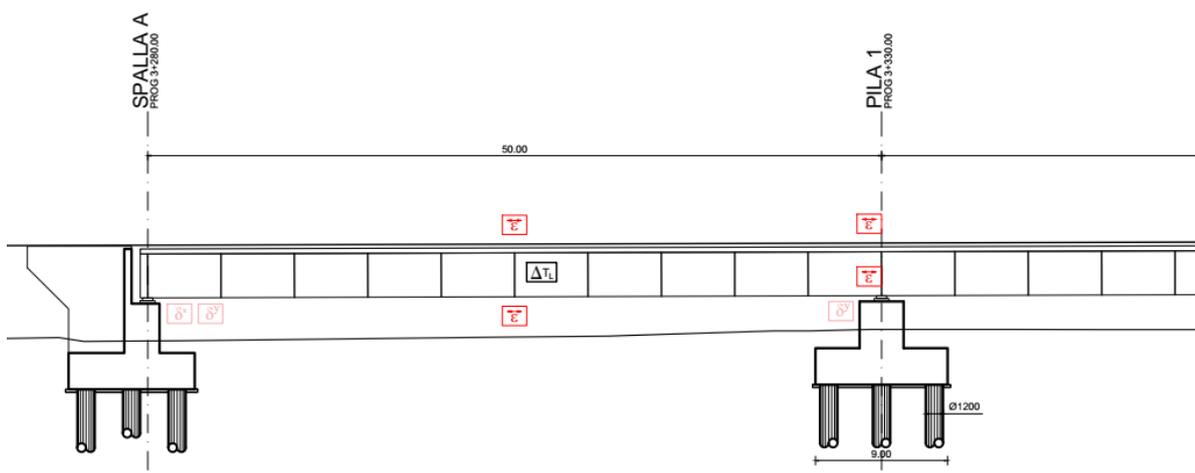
Ubicazione sensori su impalcato (sezione longitudinale prima campata viadotto Tevere)
